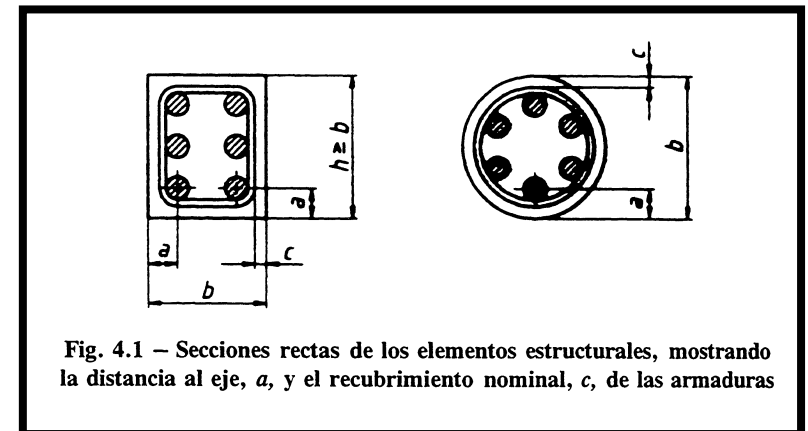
Secciones rectas de los elementos estructurales, mostrando la distancia al eje, a , y el recubrimiento nominal, c , de las armaduras
